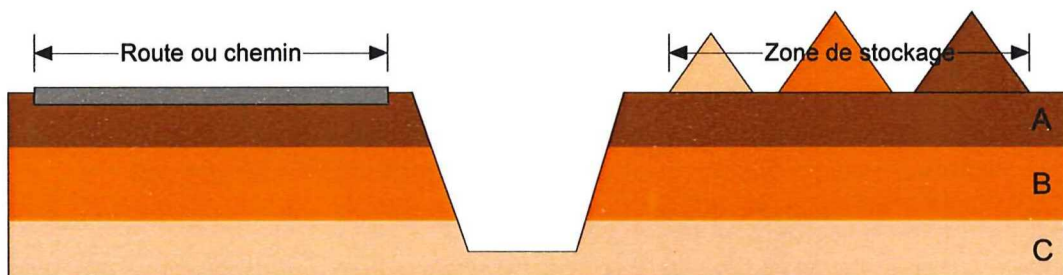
coupe-type de la zone de travail en bordure d'une route ou d'un chemin
